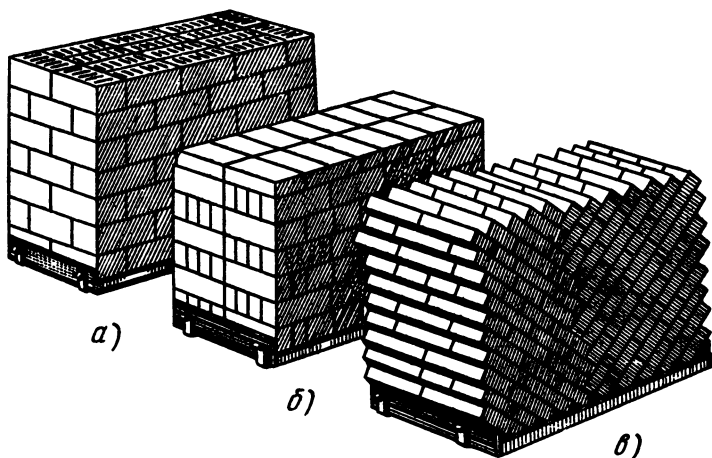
Укладка на поддонах кирпича с перевязкой: а, б — перекрестной, в — «в елку»
